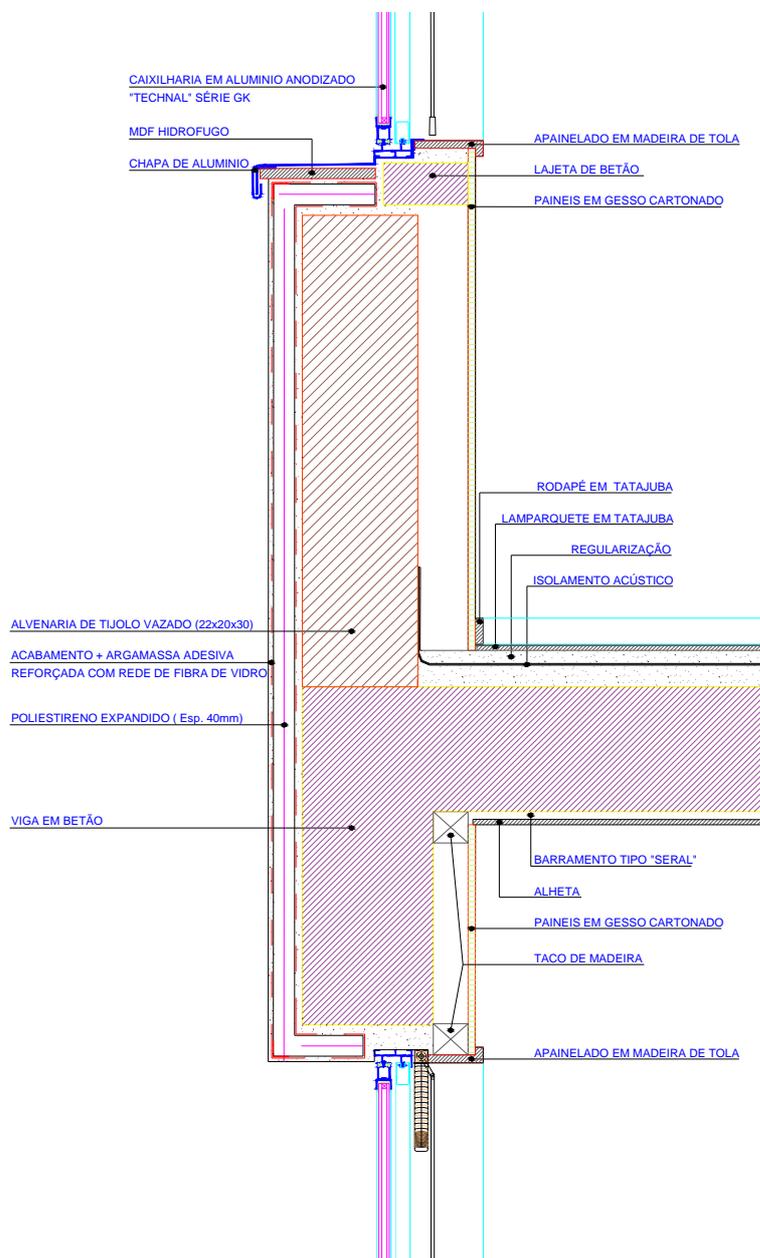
Pormenor (P3) da fachada (Cortesia Soares da Costa, S.A.)
